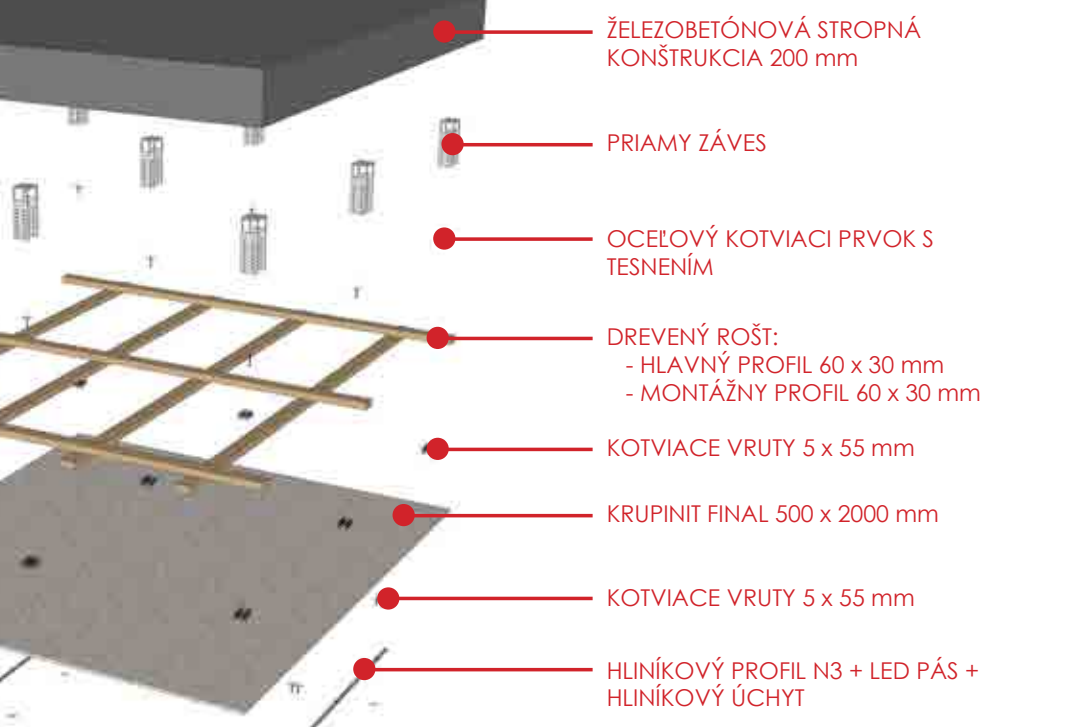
DETAIL B - UKOTVENIE PODHĽADU A ÚPRAVA HRÁN DOSIEK
